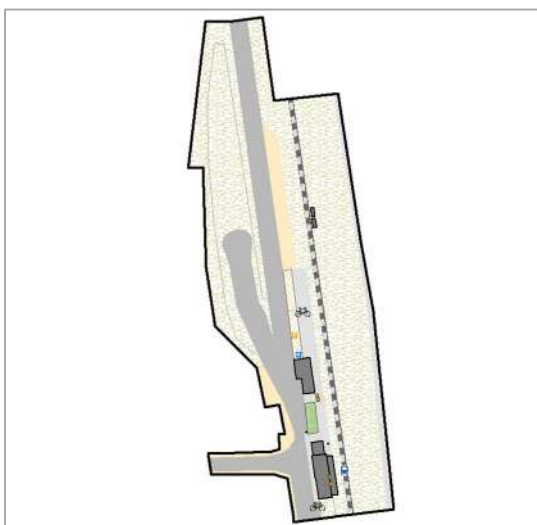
Organisation générale de la place de la Gare - Photo 72 : Différentes parties de la place de la Gare
